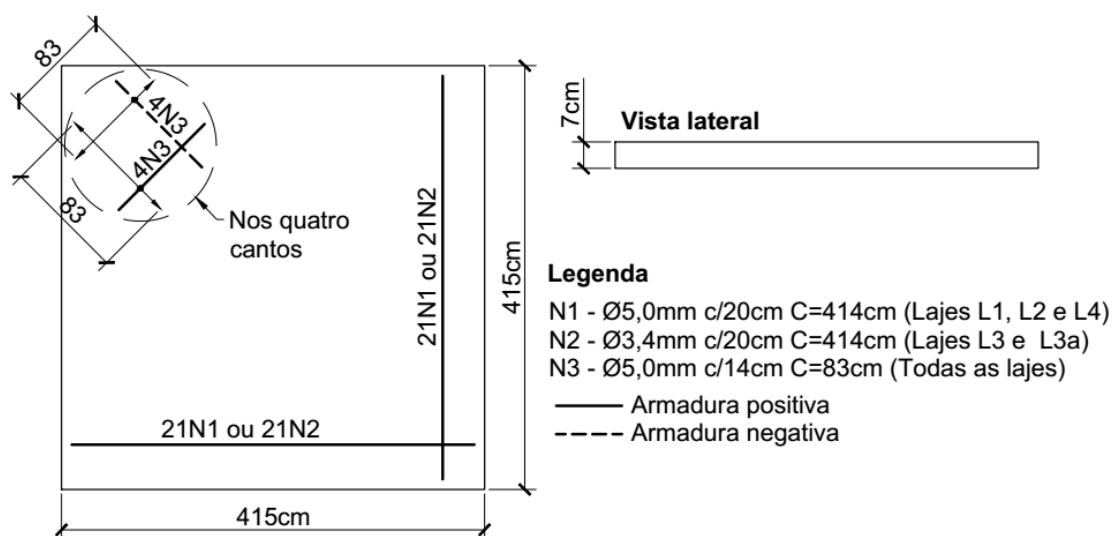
Detalhamento das lajes ensaiadas (CAMPOS, 2000).
